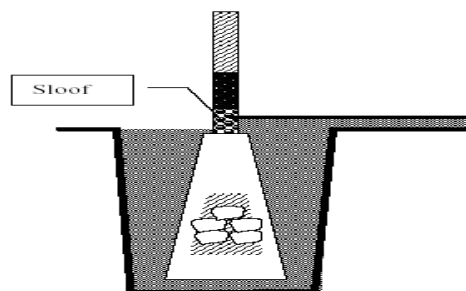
Bentuk rangkaian Pondasi Pijler dengan tampak samping.
